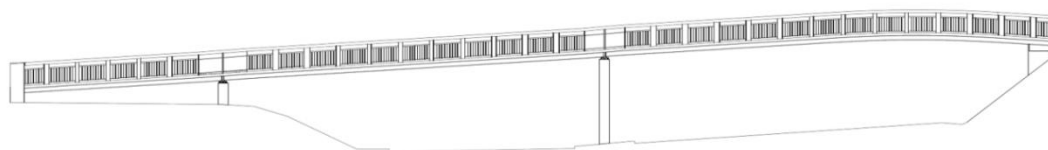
Alçado sul planificado do passadiço pedonal [2]
